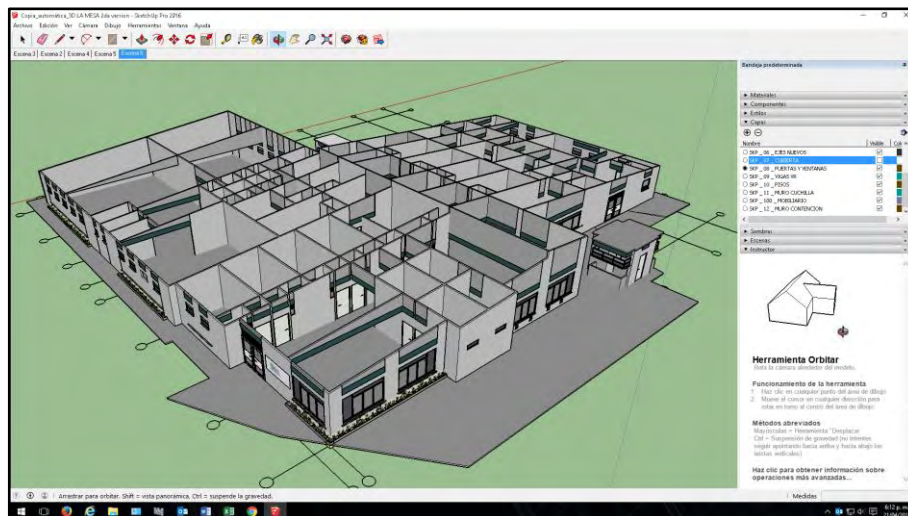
Vista estructuras internas hospital Pedro León Álvarez.
